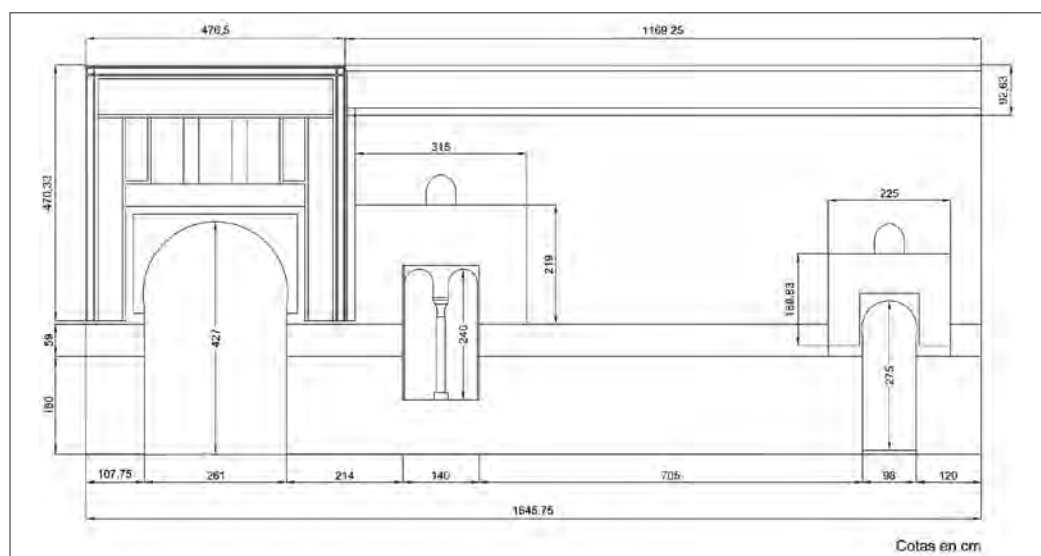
Planimetría de la zona estudiada. Muro sur/este. Patio de las Doncellas. Real Alcázar de Sevilla.
